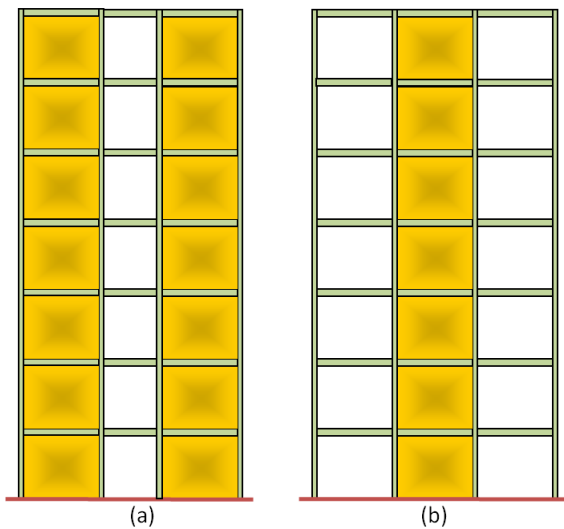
Configuraciones para muro de corte con placas de acero.
